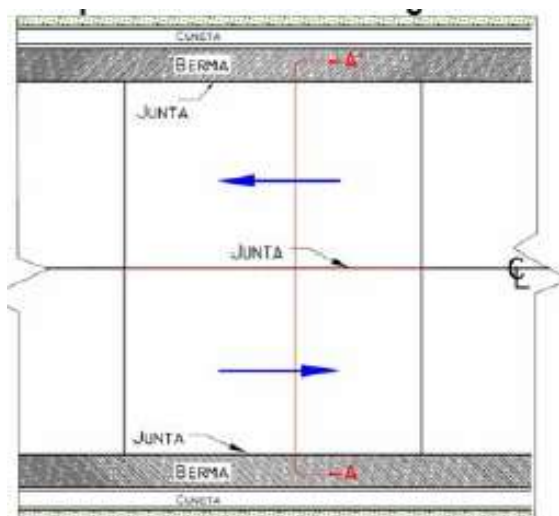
Separación de junta (SJT-SJT) (INVIAS, 2006).
